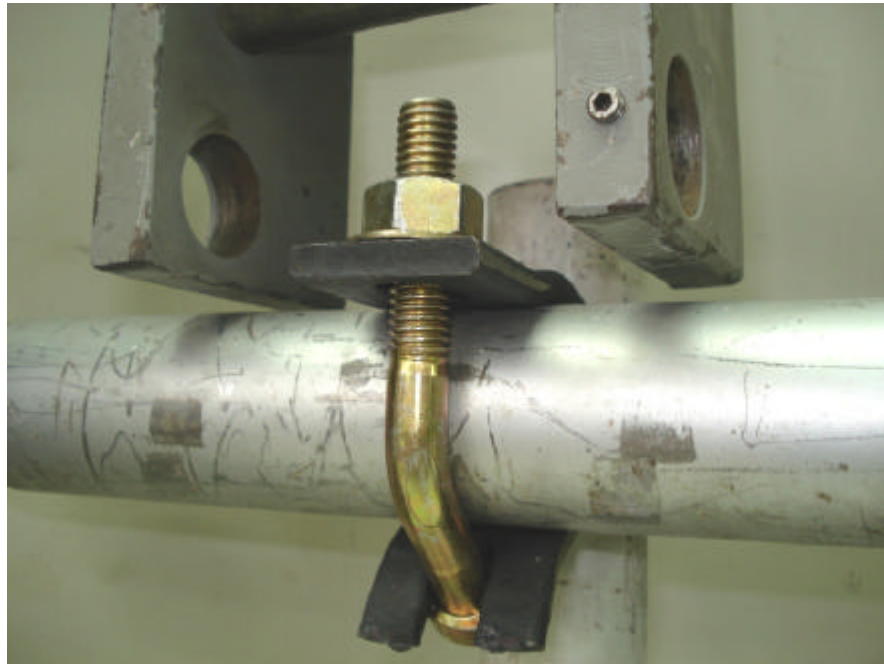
SISTEMA PARA ENSAIO DE ESCORREGAMENTO EXCÊNTRICO
